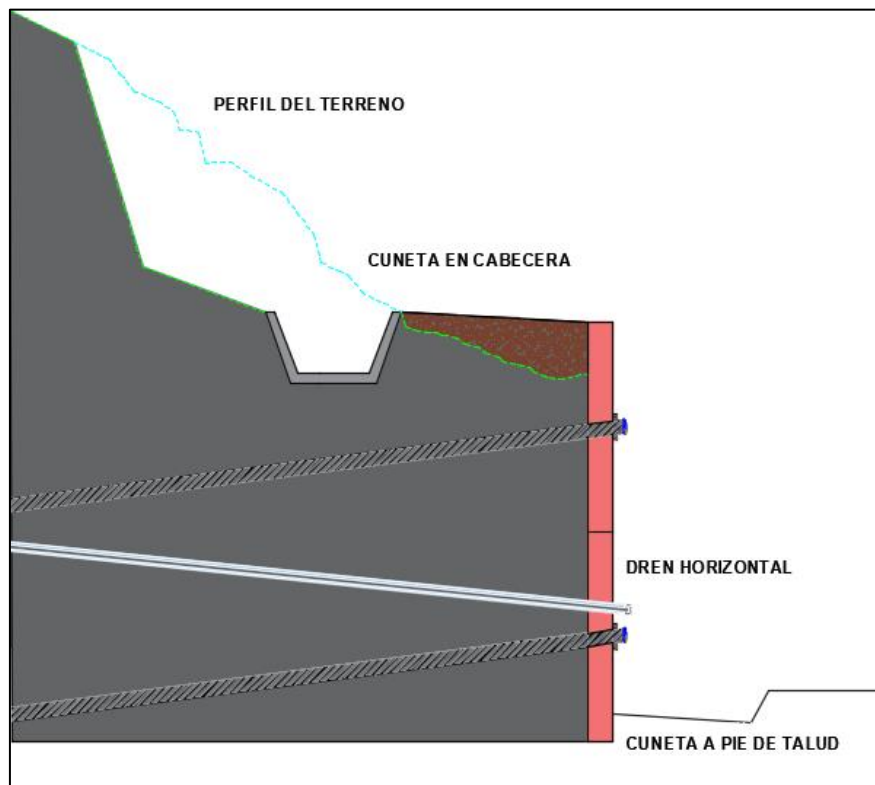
Esquema de la red de drenaje de una sección tipo. Fuente: Propia
